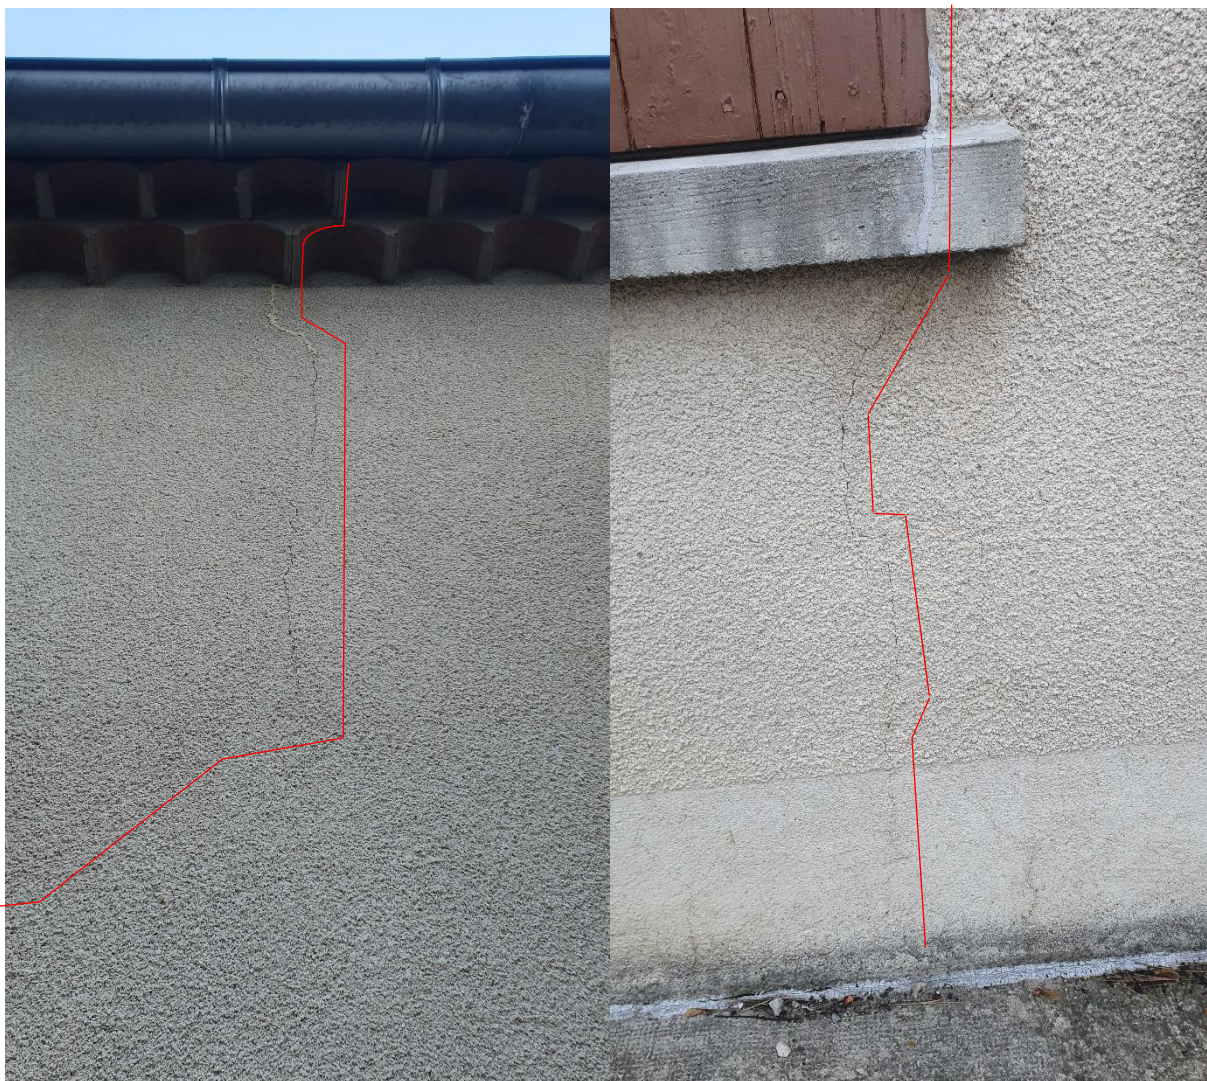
fissures observables sur la façade ouest au niveau de la fenêtre de la chambre 1 a) partie supérieure ; b) partie inférieure
